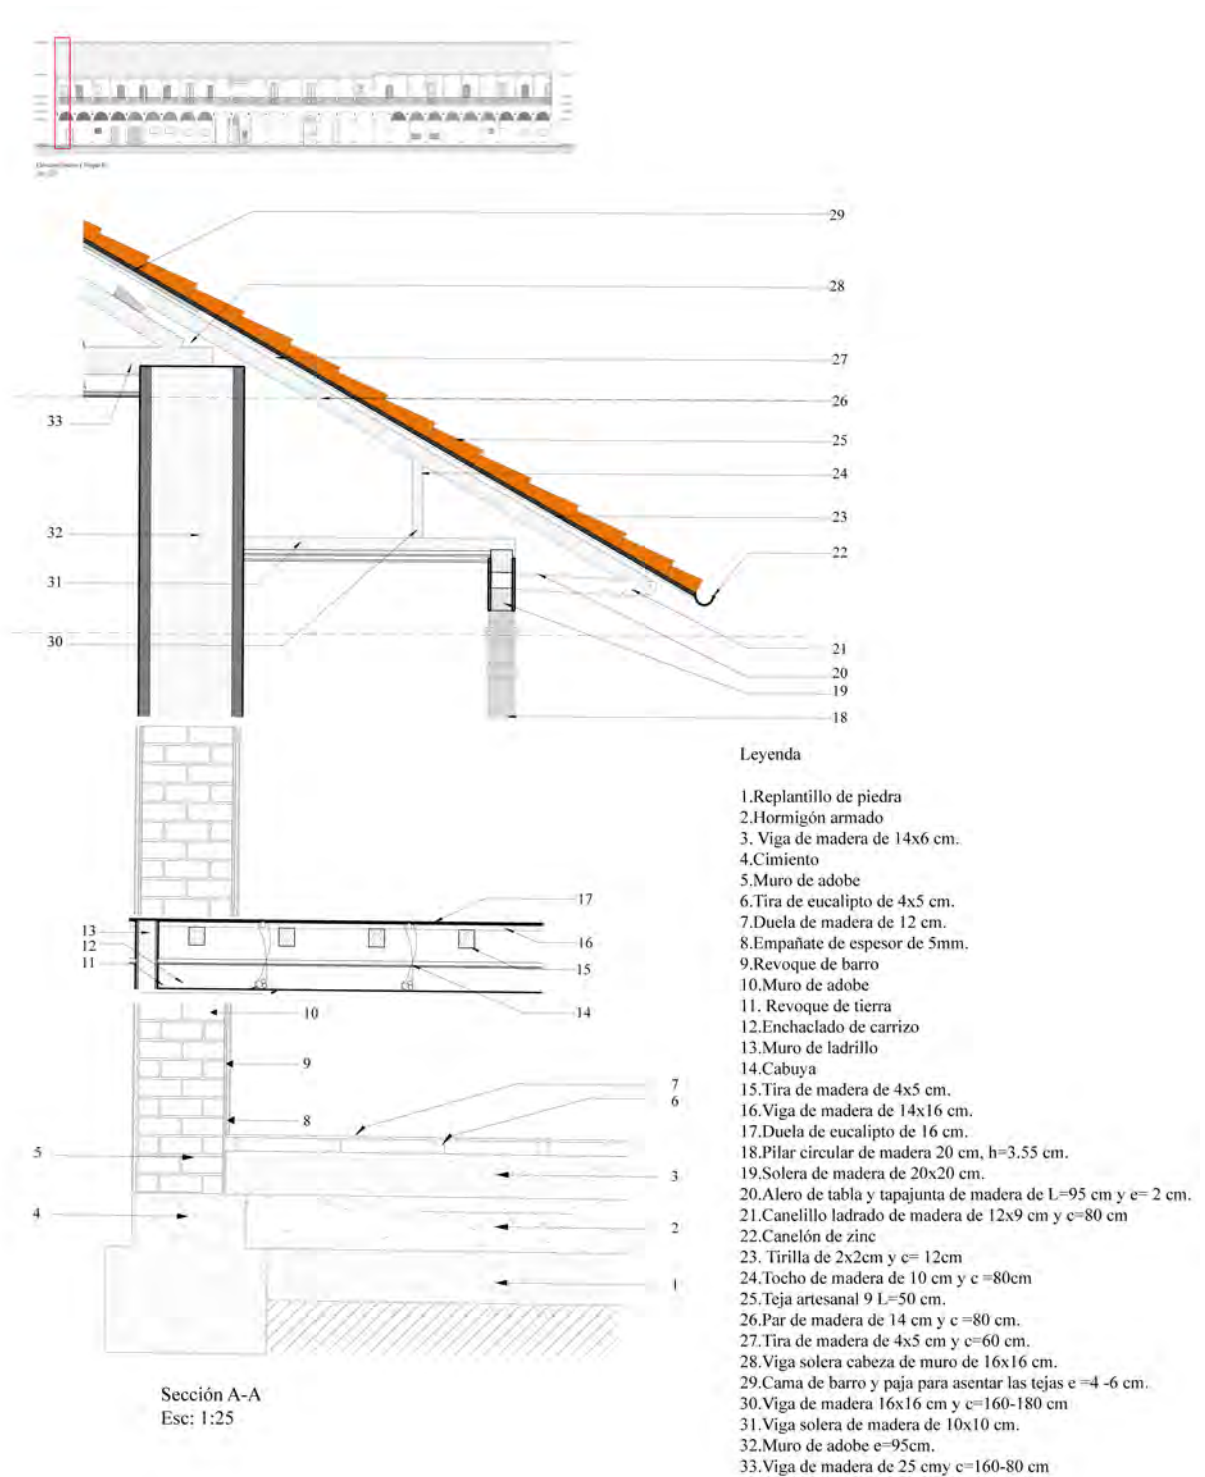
Sección constructiva. Fuente y elaboración: propia
